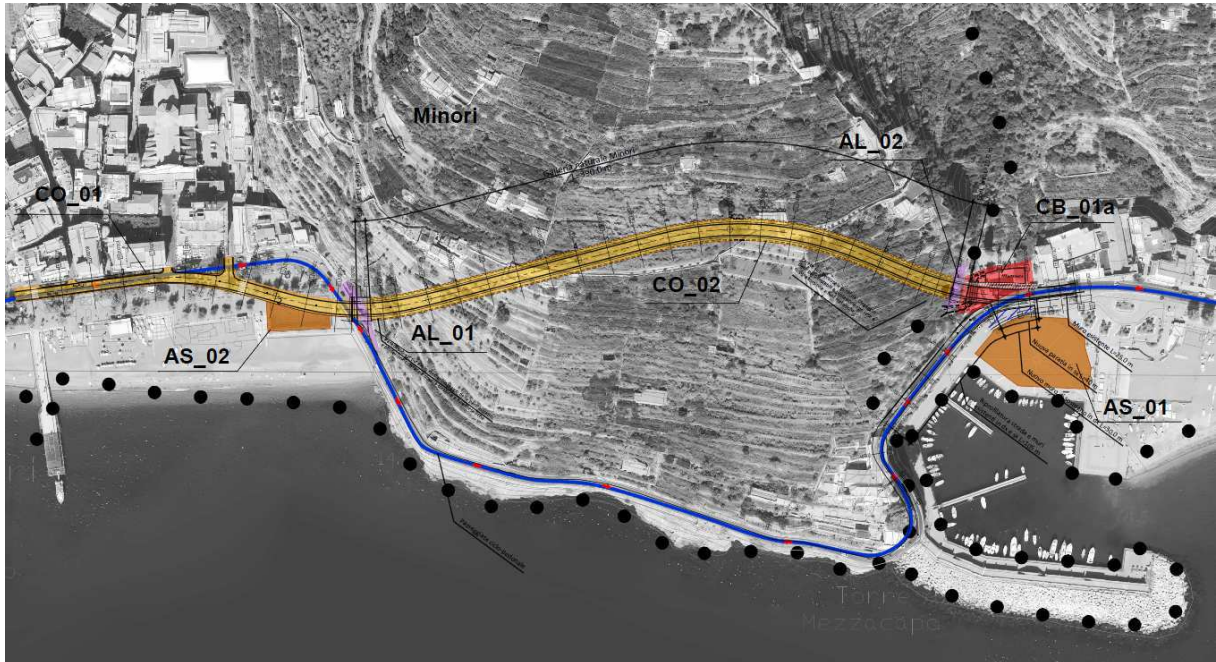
Localizzazione aree di cantiere fase 1, Stralcio tavola "Planimetria aree di cantiere e viabilità" (T00IA04CANPL01A)
